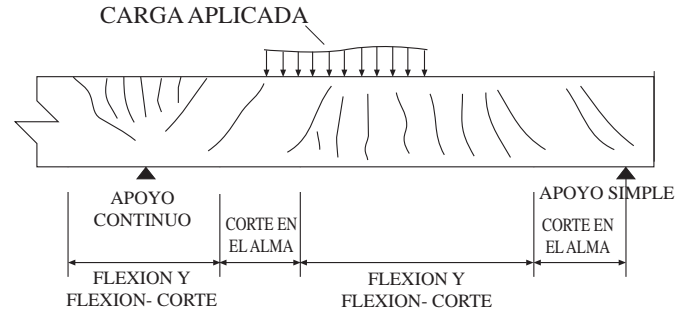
Tipos de agrietamiento en vigas de hormigón.
